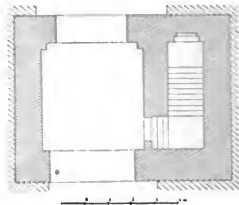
Melnik. Grundriss des Prager Thores.
